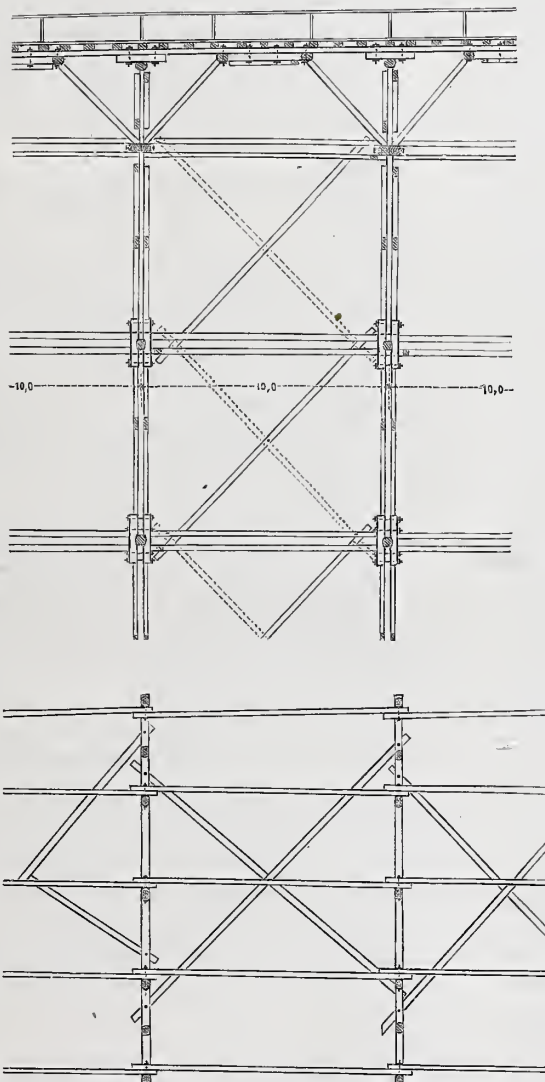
Seitenansicht und Grundriss des Gerüsts.
